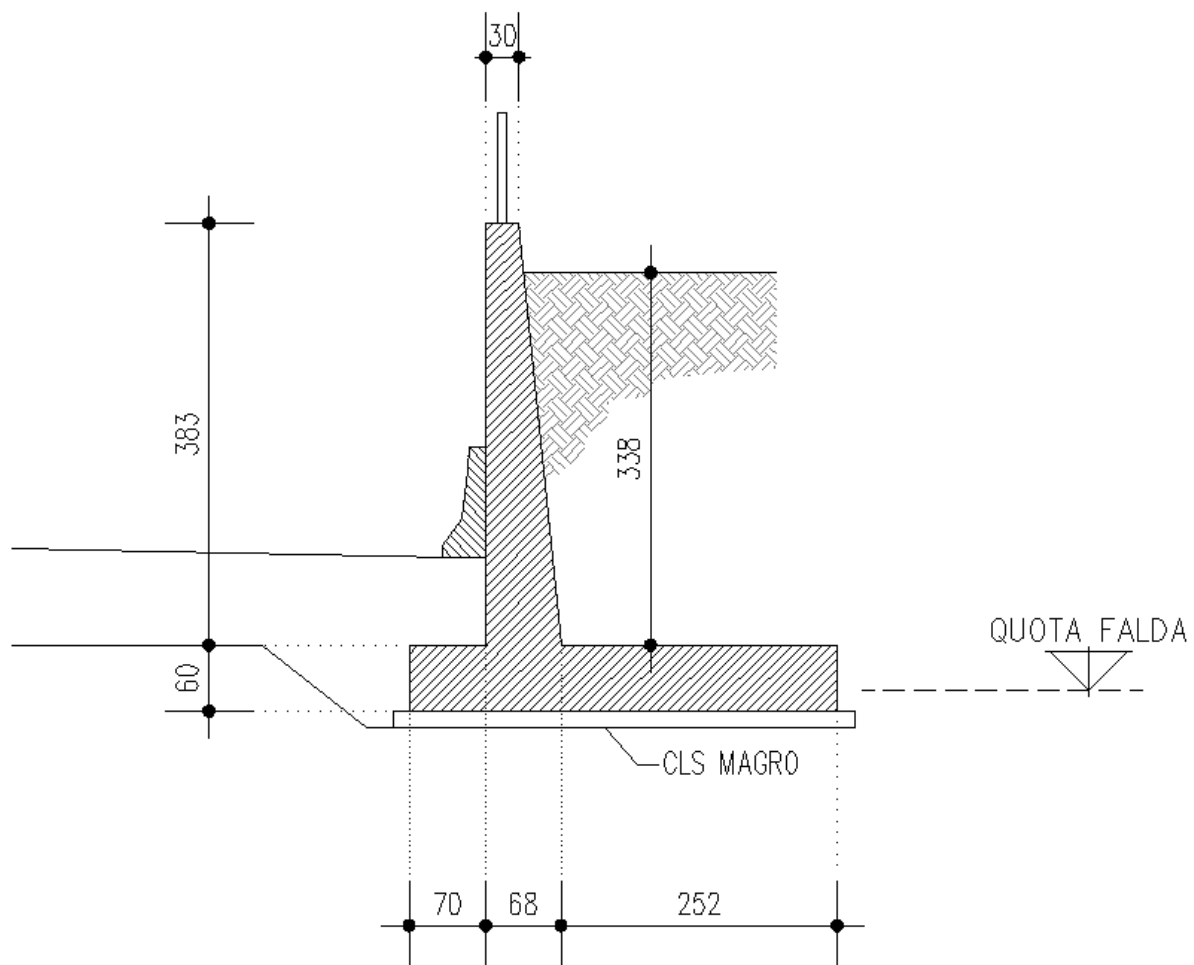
GEOMETRIA DELLA SEZIONE DEL MURO AD L
